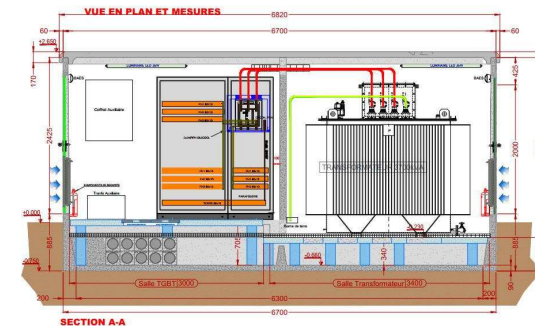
Exemple de plan de coupe de face d'un PTR (Source : SOLARVIA)
